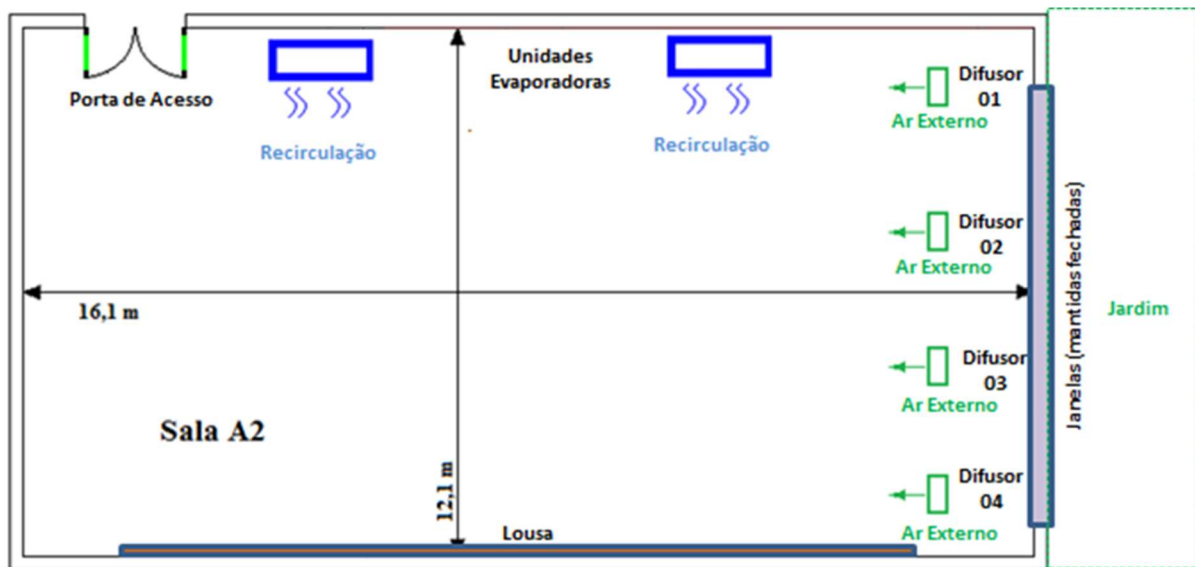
Planta da Sala A2 (adaptado de Fakhoury, 2017).
